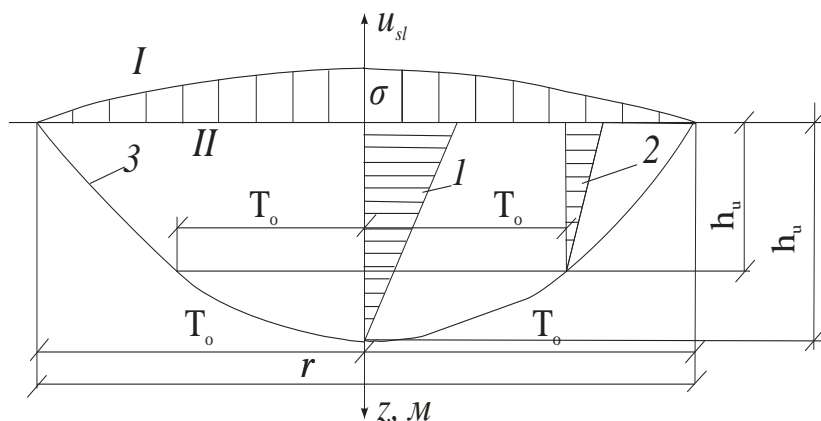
Схемы для примеров расчета просадок фундаментов от собственного веса грунта при замачивании
